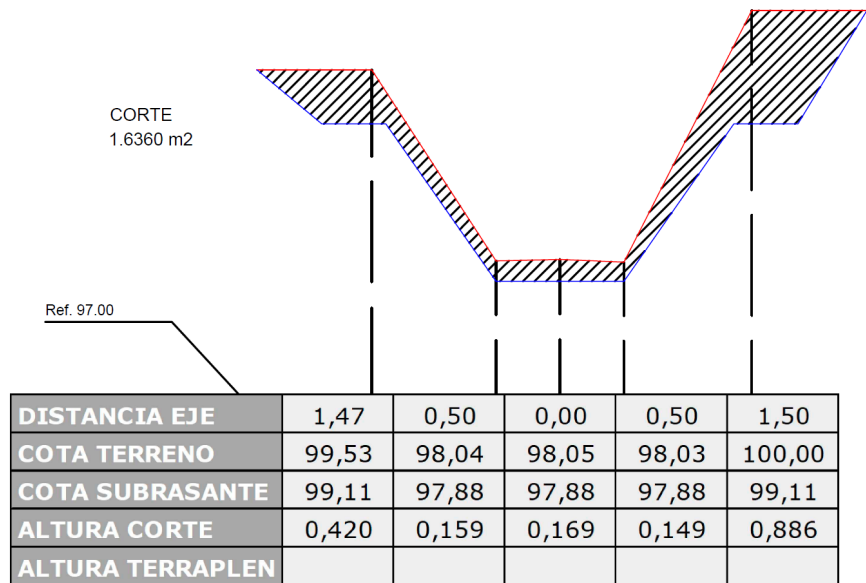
Perfil Transversal N°4 (Fuente Propia)
